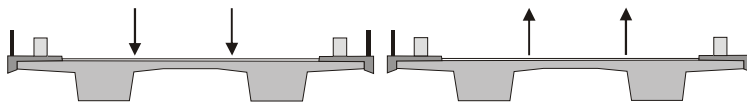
Beispiel für Brücken mit zweiteiligem Querschnitt (getrennte Überbauten für beide Richtungsfahrbahnen)
